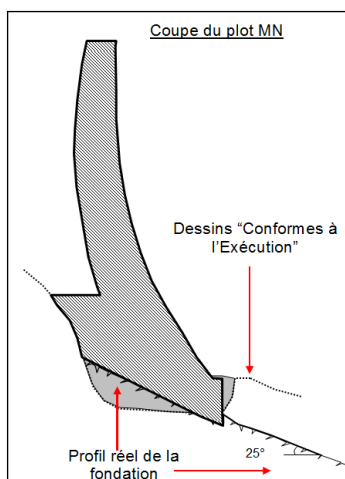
Différence entre les plans de construction et le profil réel de l'excavation du barrage du Piney (42)
